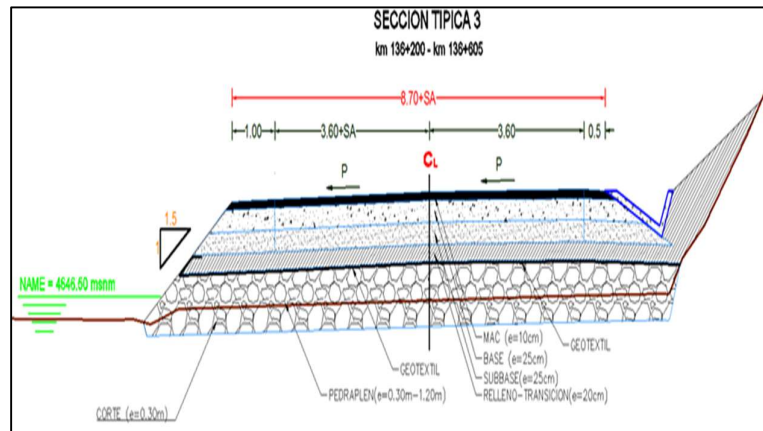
Sección típica de la estructura de pavimento no convencional.
